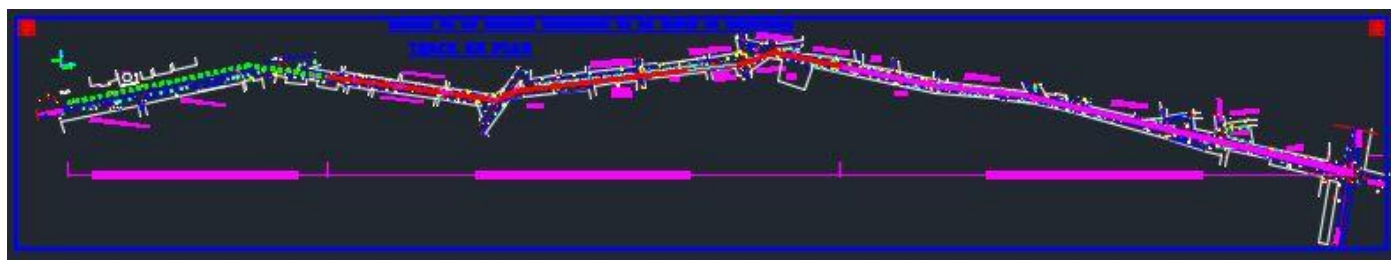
Trace en plan des trois tranches de galerie réalisé[6]
